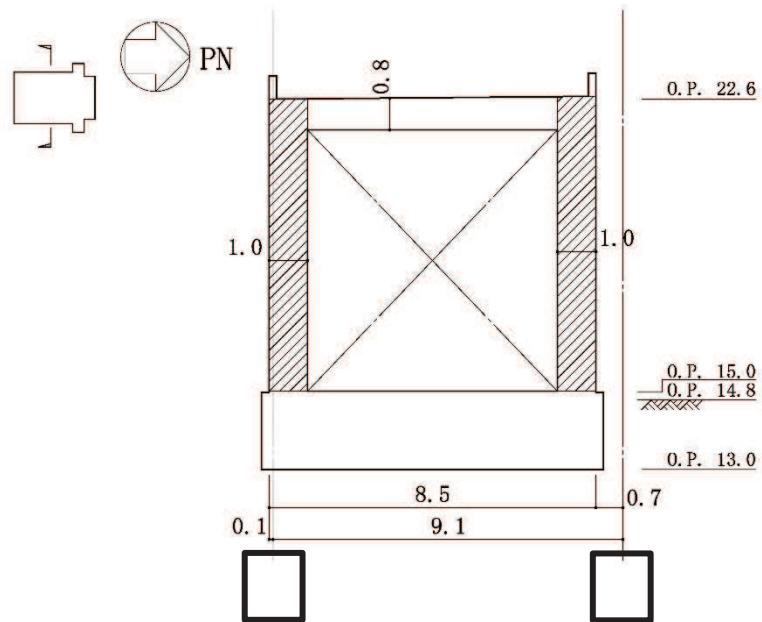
(2) 2次しゃへい壁の範囲の平面図 (RF, 0.P. 22.6m)
